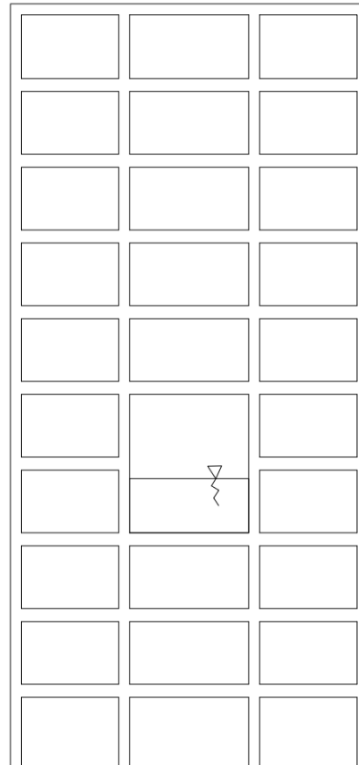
Deah Lantai 1-9 (Unit Apartemen, Kecuali di Lantai Kolam Renang)
